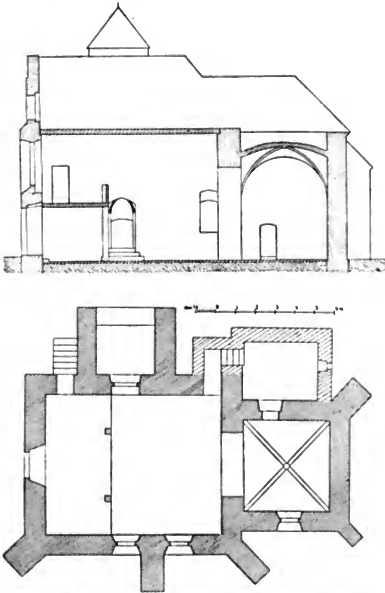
Kpy. Längendurchschnitt und Grundriss der Kirche.
